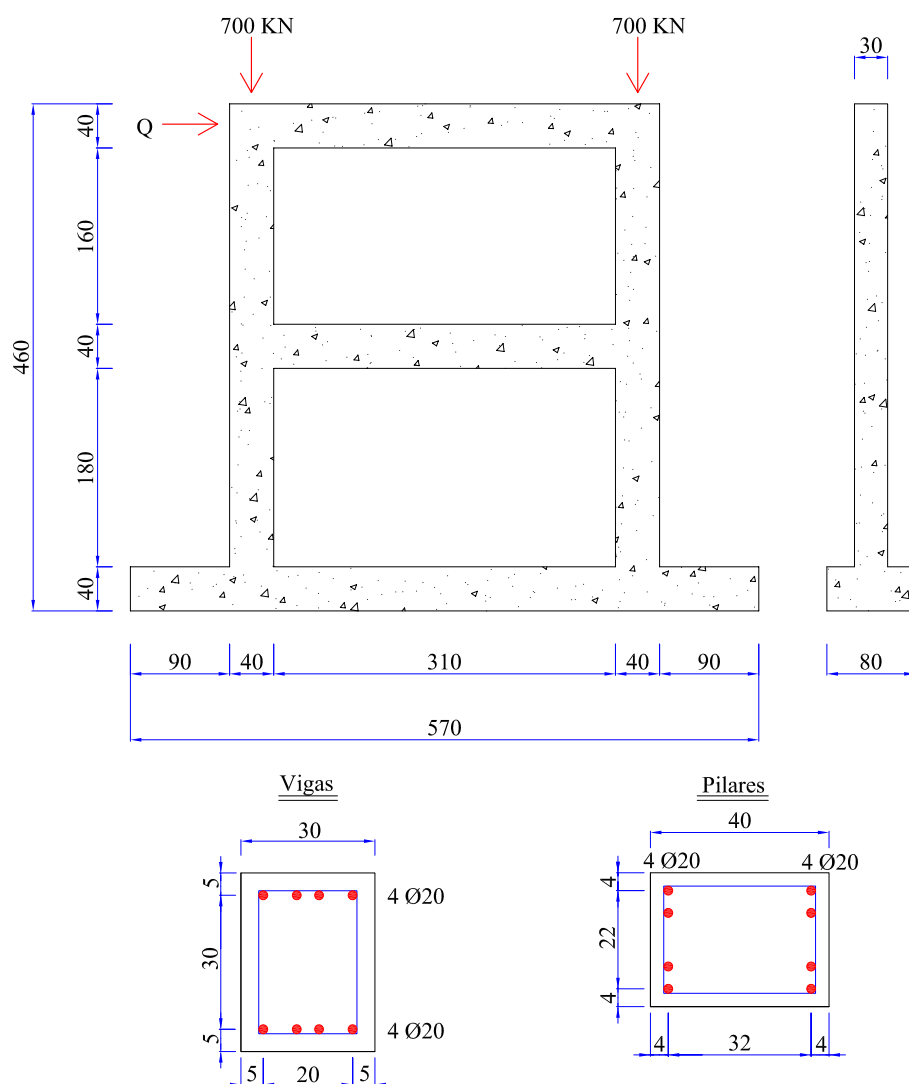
Detalhes da geometria, carregamento e armadura do pórtico.
